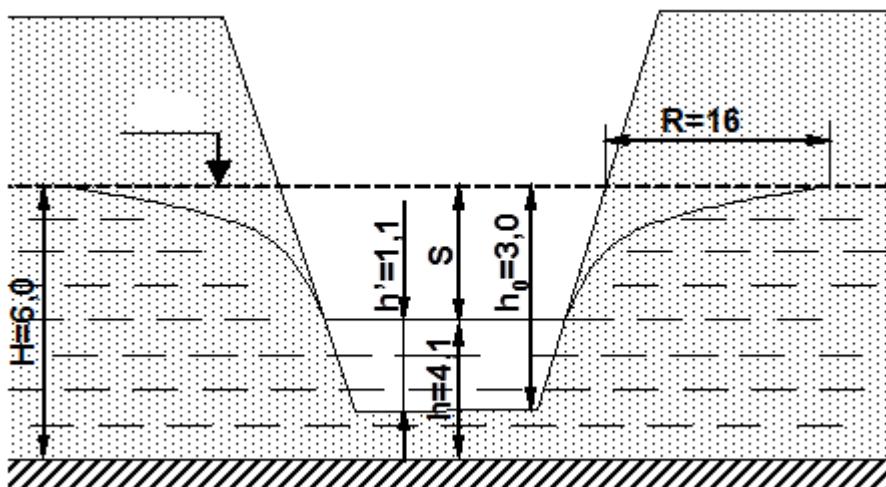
Схема для расчёта притока грунтовых вод к канаве.
